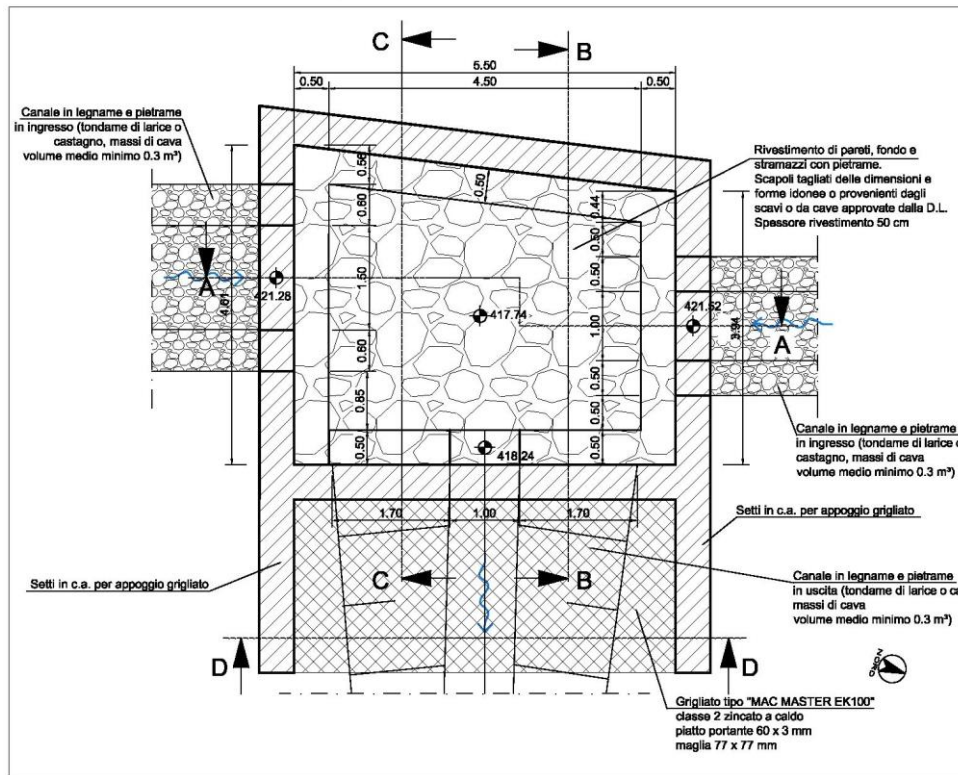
Compluvio centrale – Vasca Vi7 - pianta
